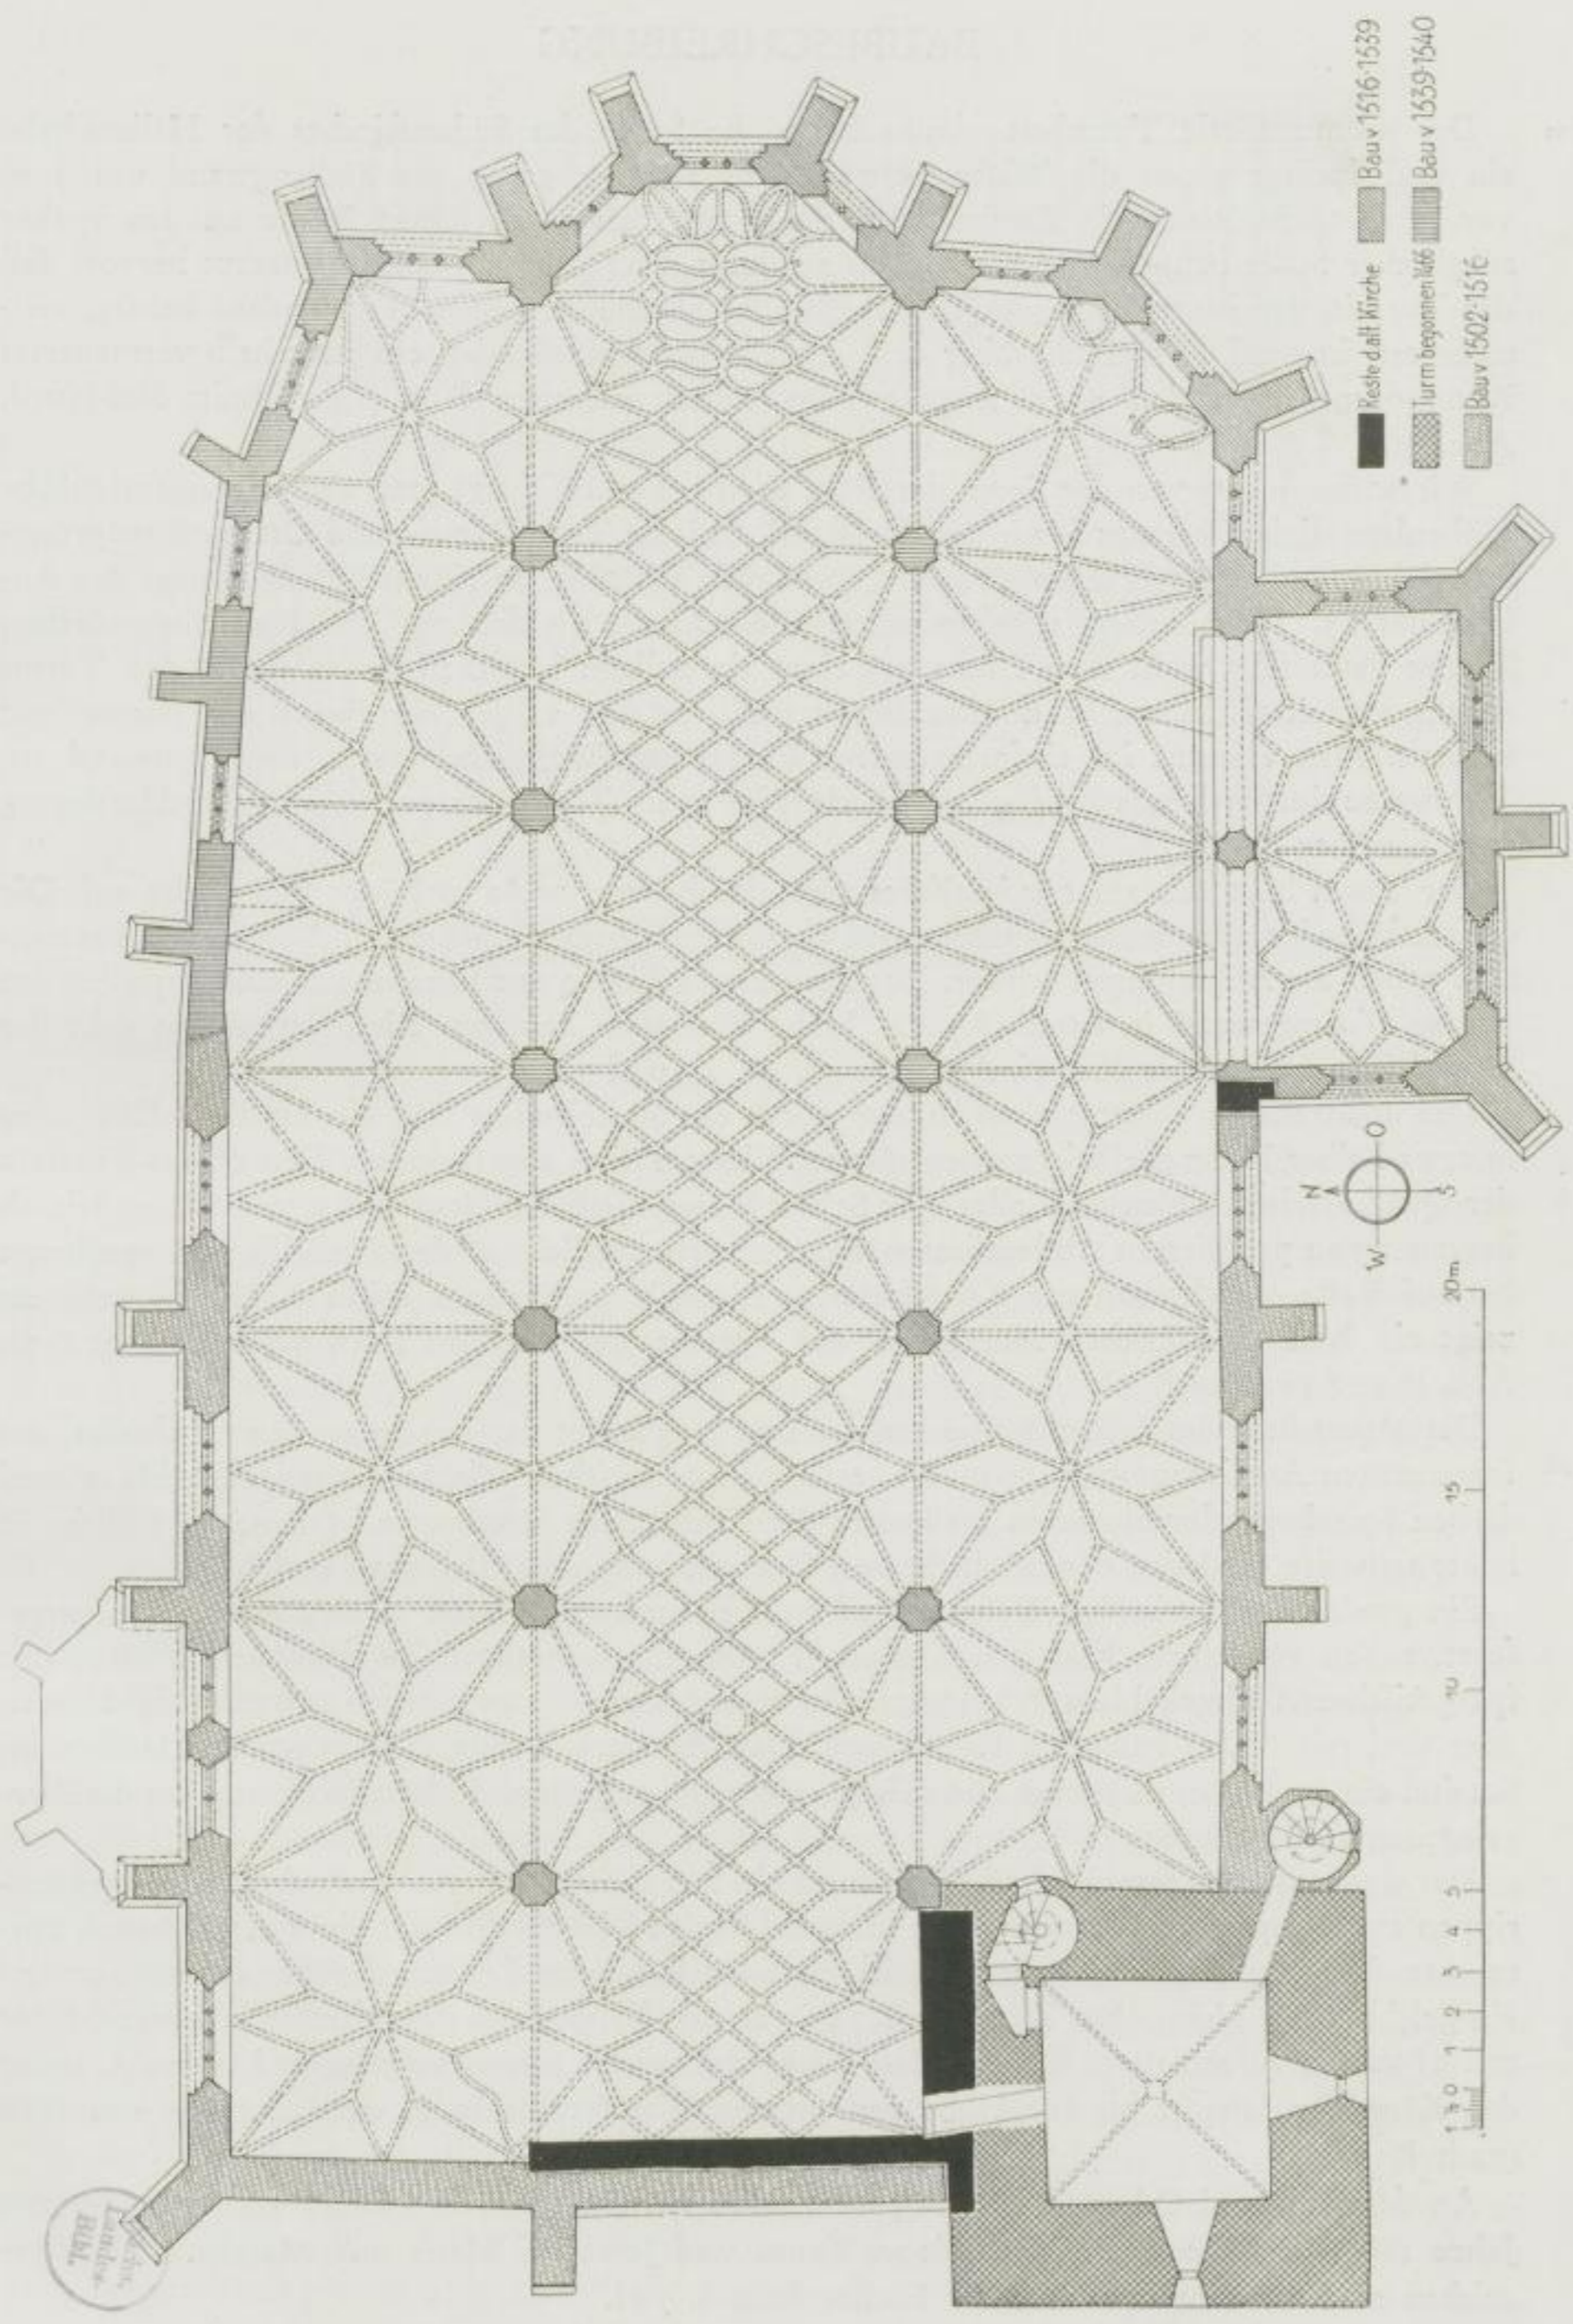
Grundriß der Stadtkirche in Fensterhöhe (Aufn. Krebs)
